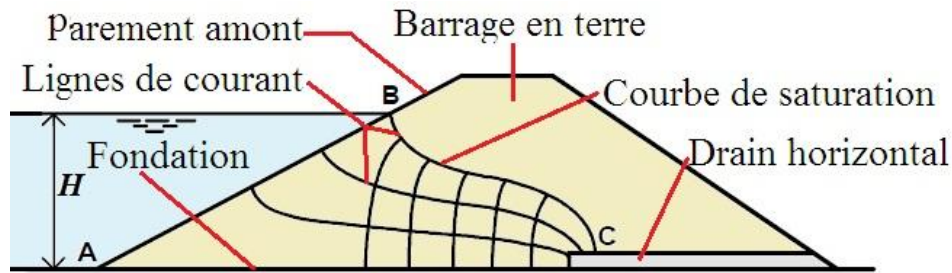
Ecoulement dans le corps d'un barrage en terre drainé horizontalement, (potentiel nul au niveau du drain).
